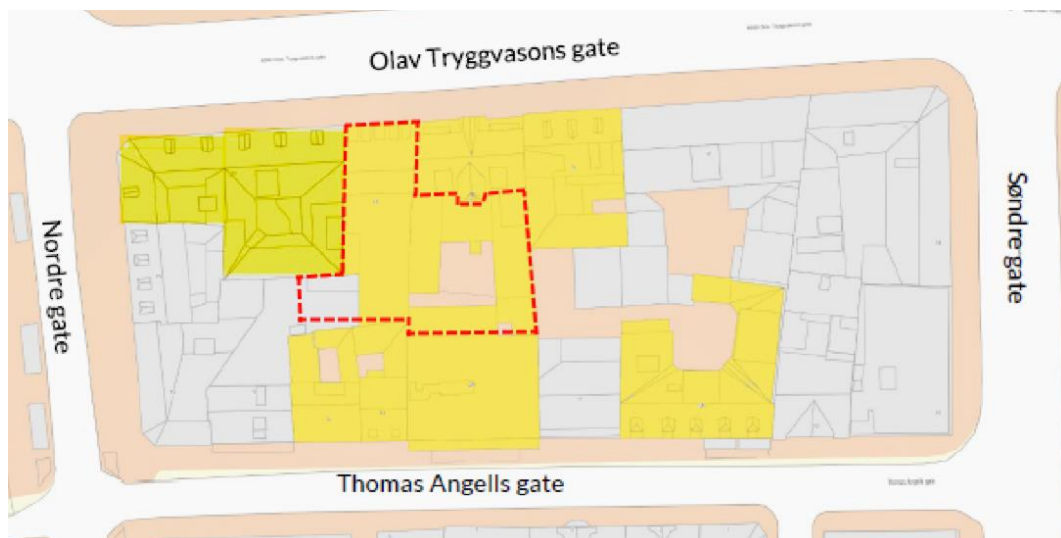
Situasjonsskart – Rødt omriss viser avgrensning av planlagt tiltak mot eksisterende bygningsmasse.
